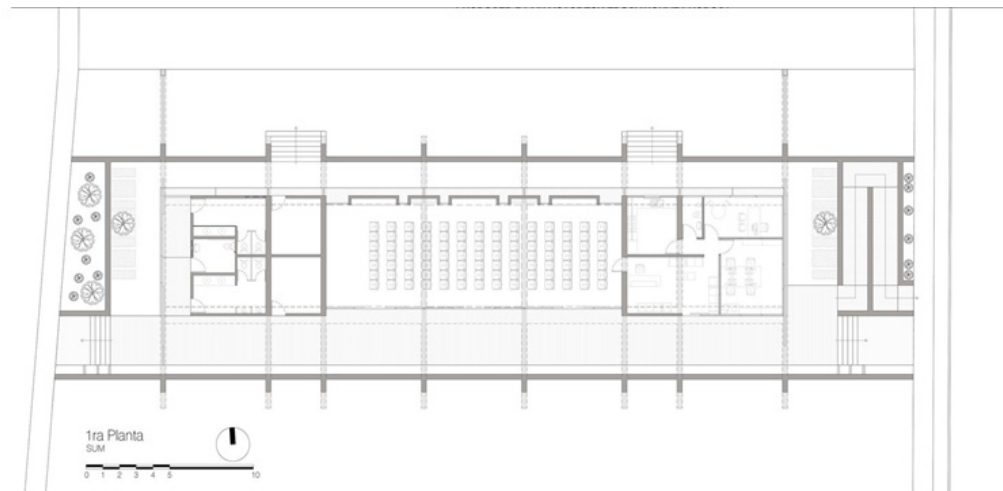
Planta 1, distribución con auditorio general. Fuente:
